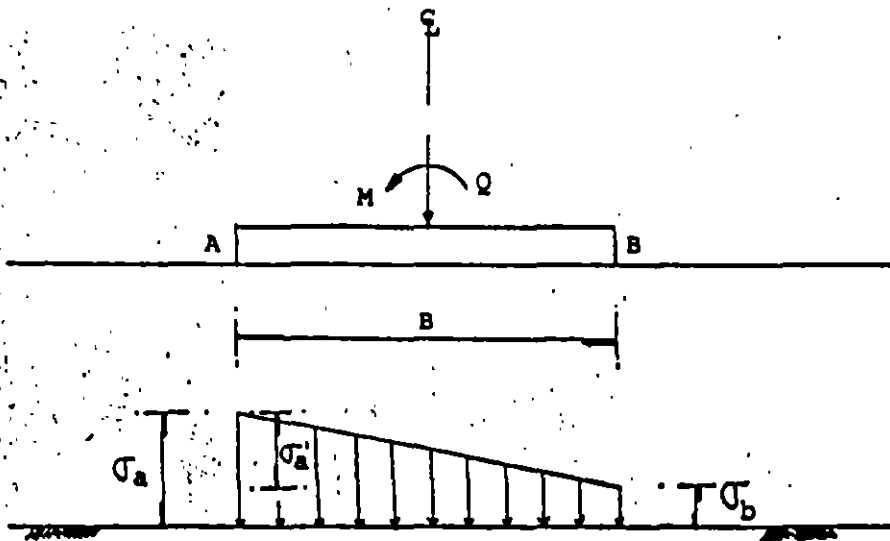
CARGA TRAPEZIAL SOBRE EL TERRENO
